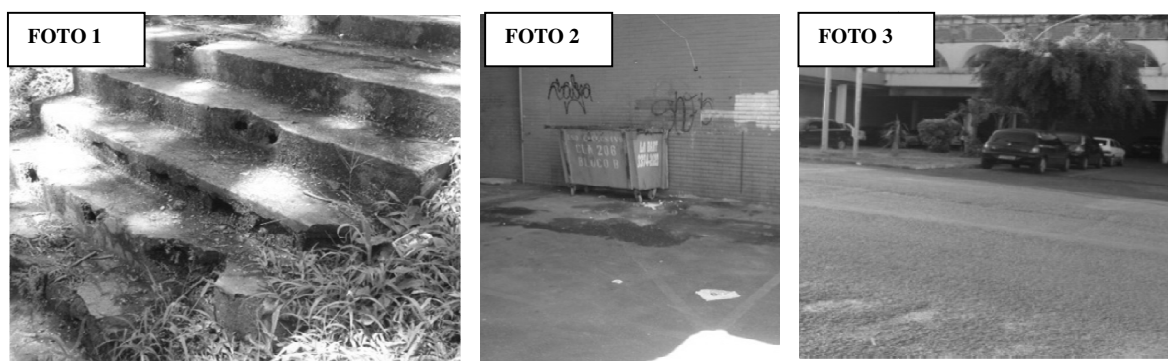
Foto 1, Escada206NCE6; Foto 2, Lixeira; Foto 3, vista panorâmica
